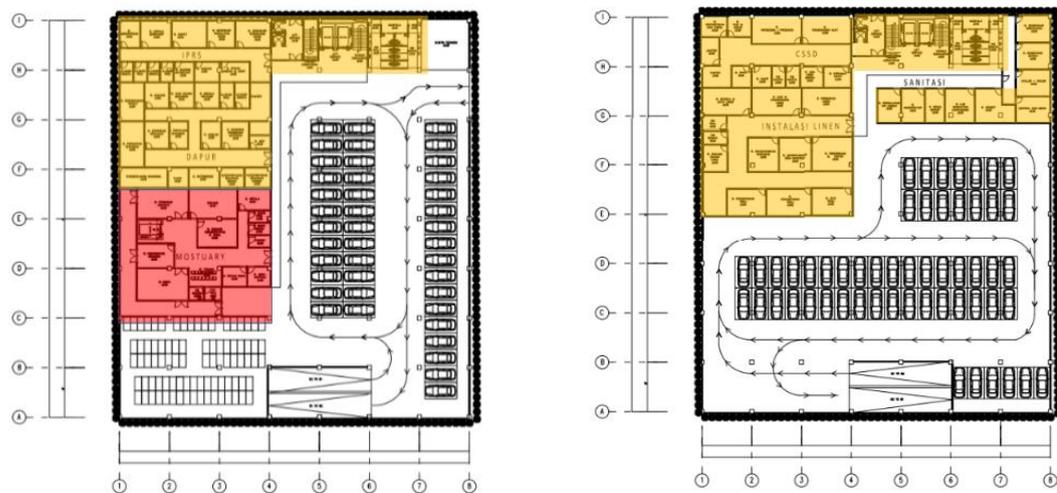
Zonasi dalam Bangunan Lantai 1 dan 2
